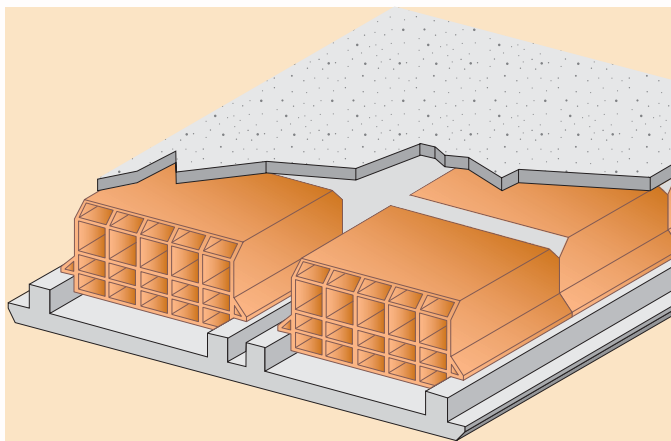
b - Solaio a lastre in c.a. precompresso irrigidito da nervature con alleggerimento in laterizio.
